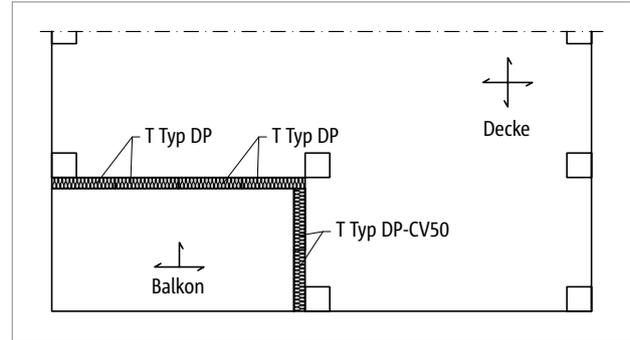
Schöck Isokorb® T Typ DP: Einsatz in Flachdecken
